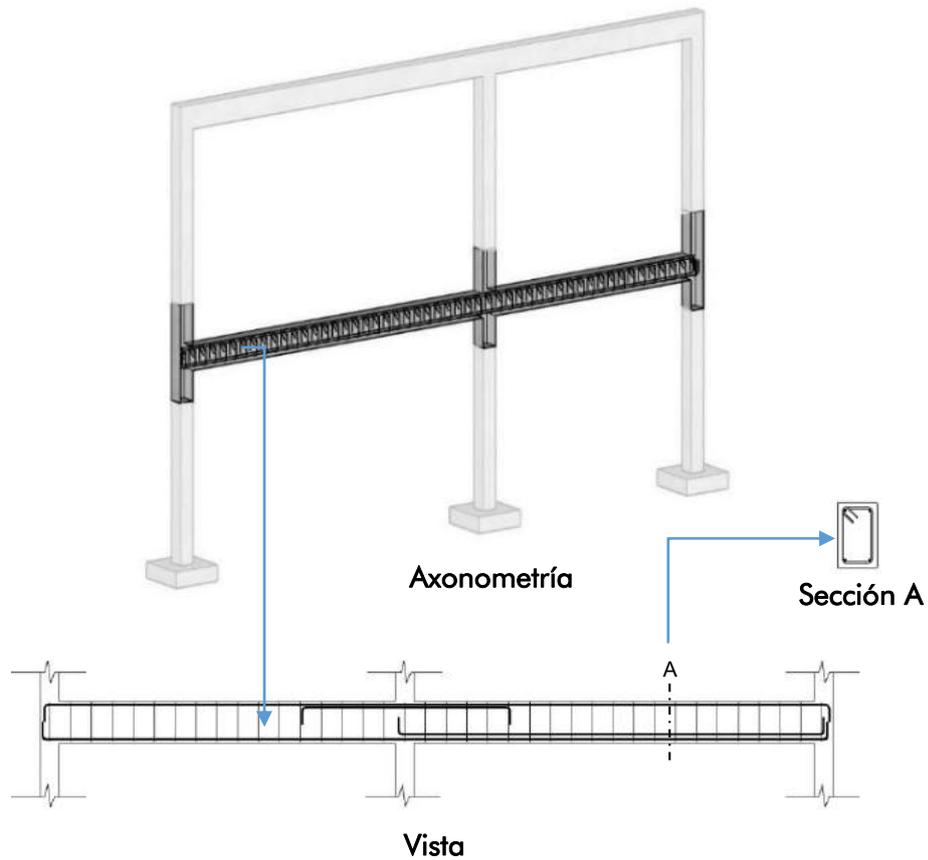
Sector a representar en vista para el detallado de armaduras de viga
